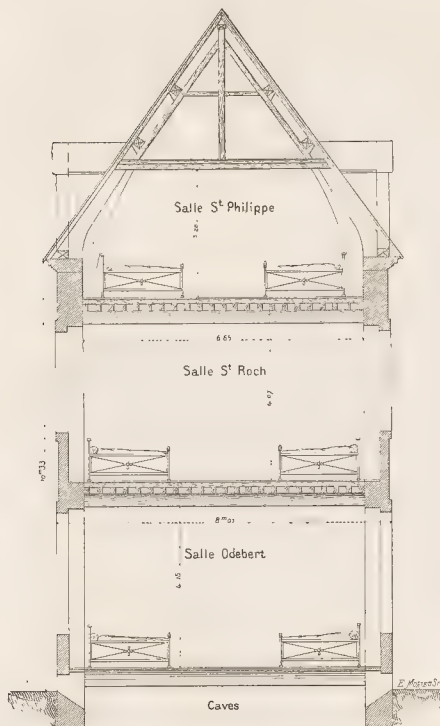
Coupe transversale sur le bâtiment portant le n° 66 du plan général.
